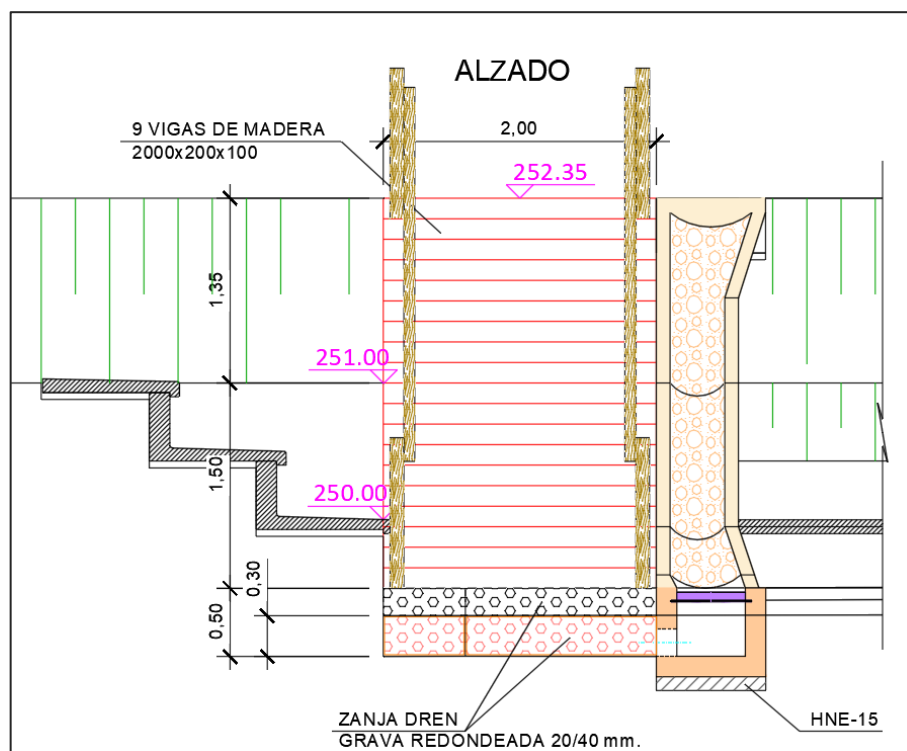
Vista en alzado de las escaleras del talud sur.
